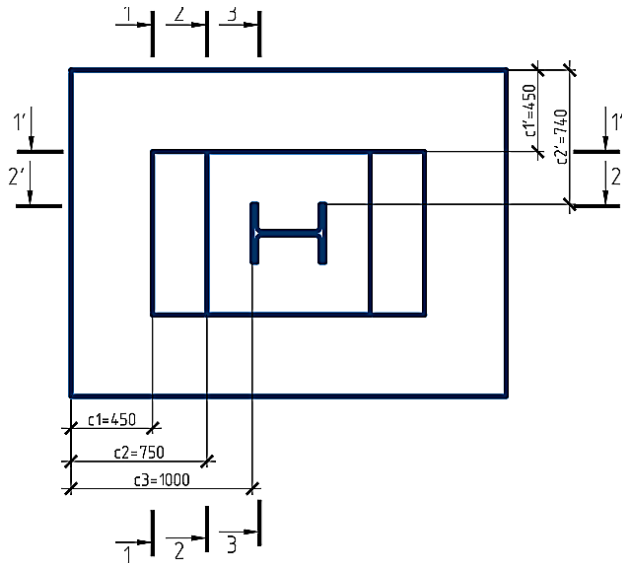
Схема к расчету арматуры плитной части фундамента
